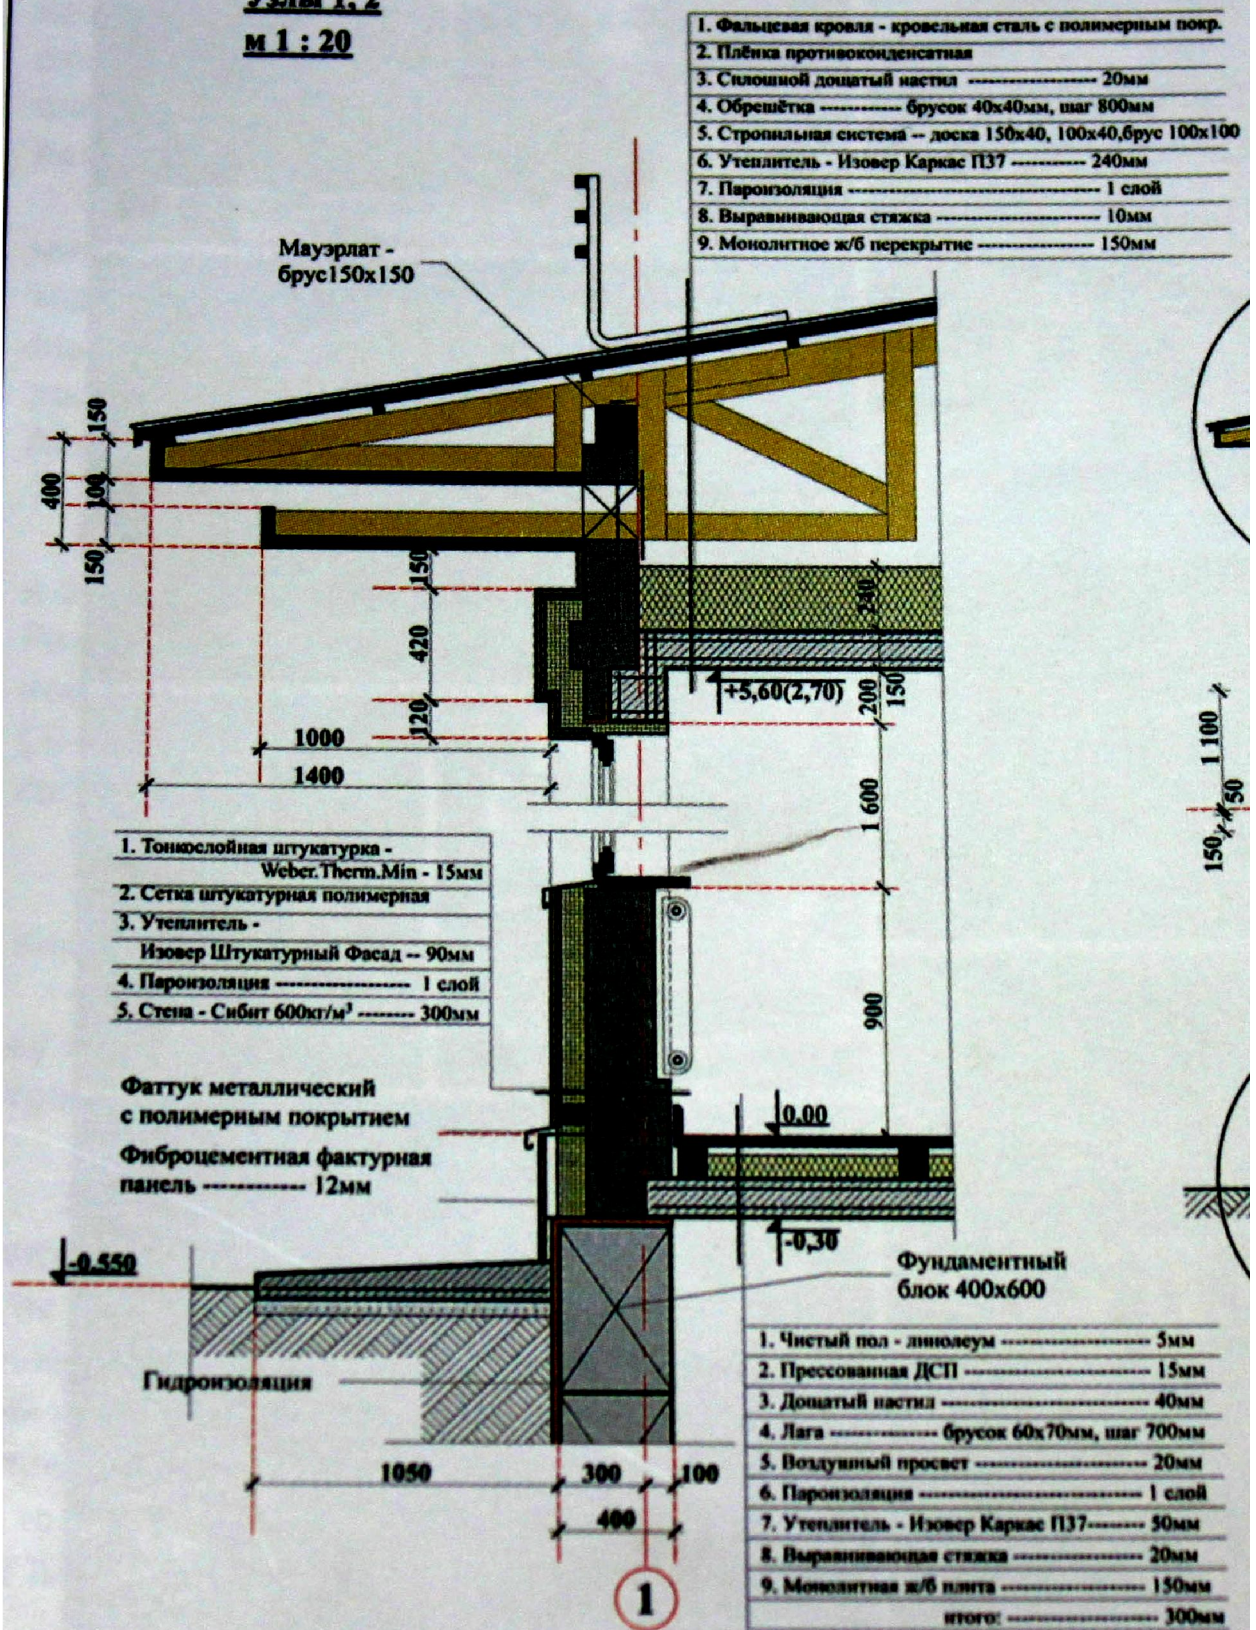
Разрез по наружной стене. Узлы 1, 2.
